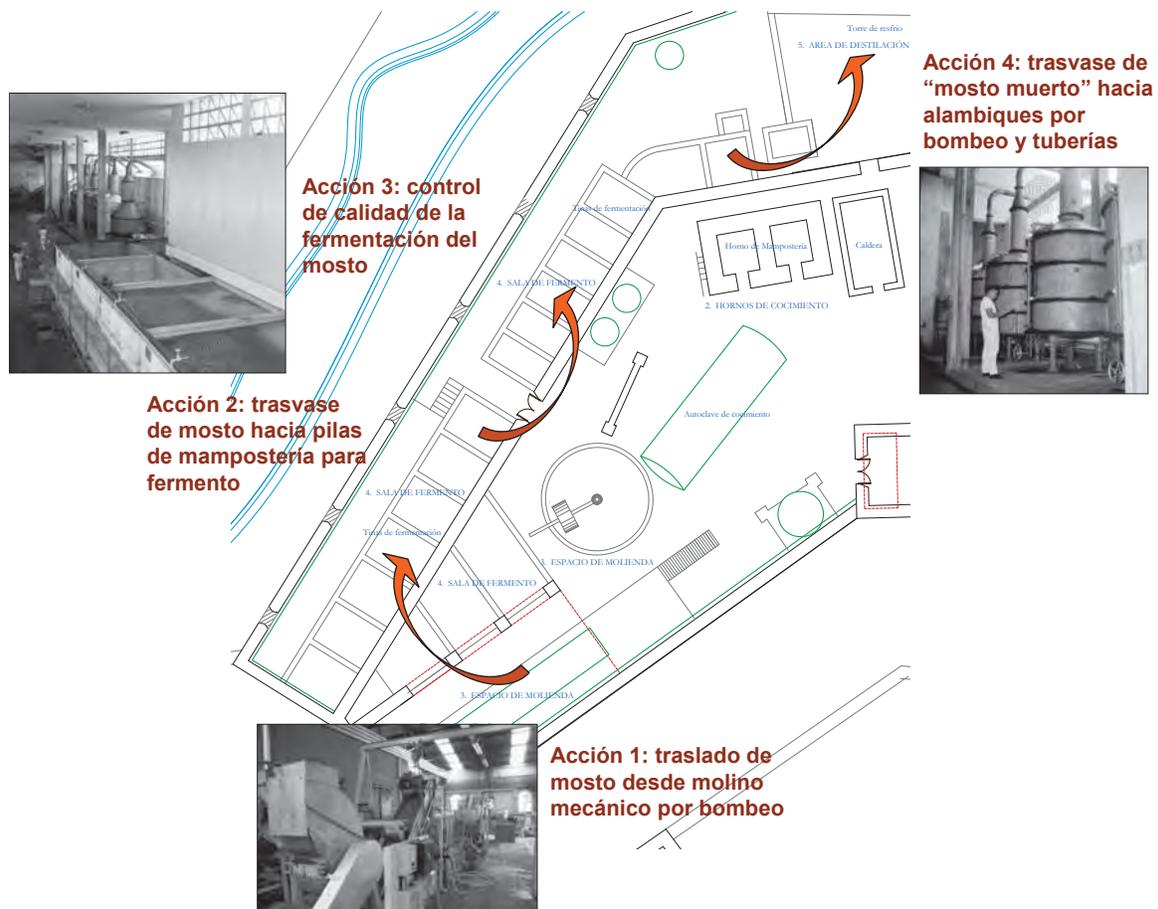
Tinas de fermentación de mampostería en la destilería de El Cascabuín en El Arenal.
